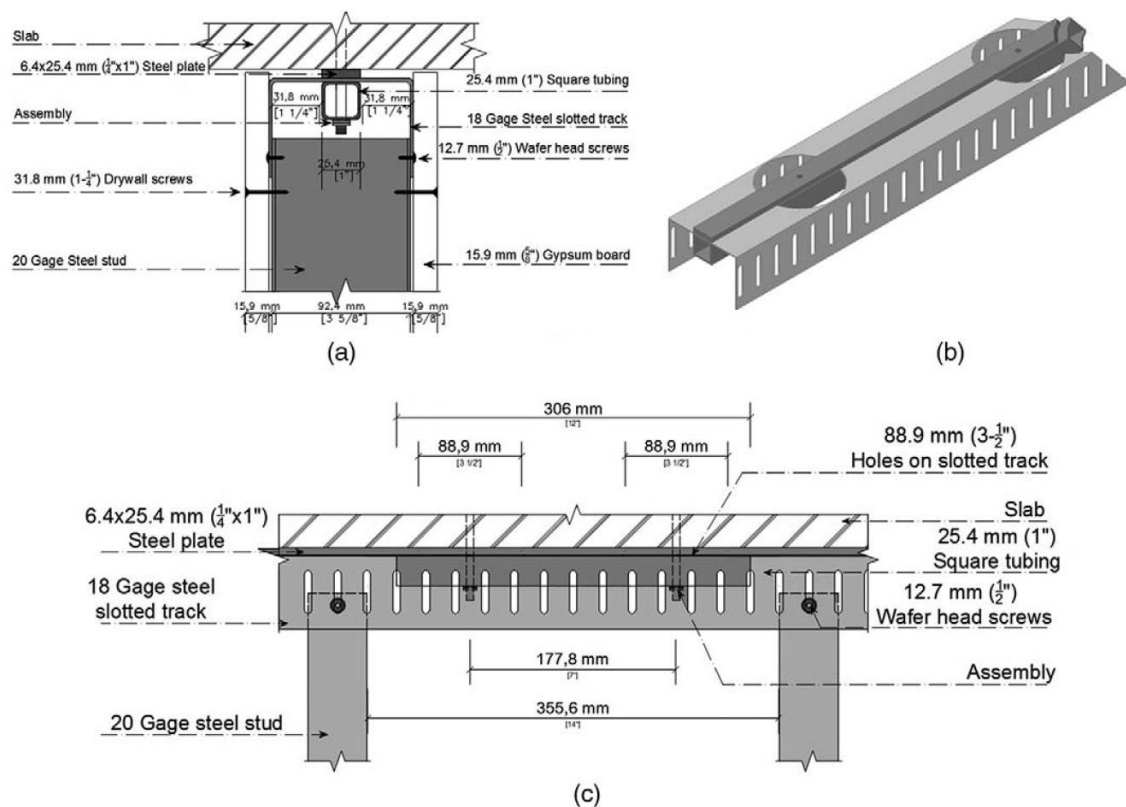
Proposta da nova conexão deslizante, a) seção transversal, b) isometria c) vista lateral/longitudinal. Adaptado de [62]
